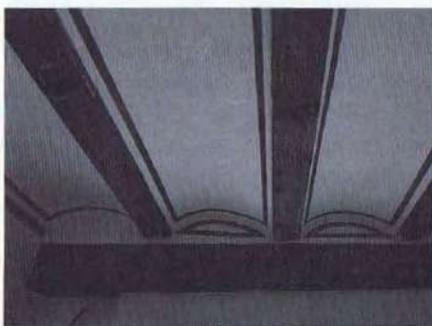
Forjado de vigas de madera y revoltones con esgrafiados tras la restauración.
